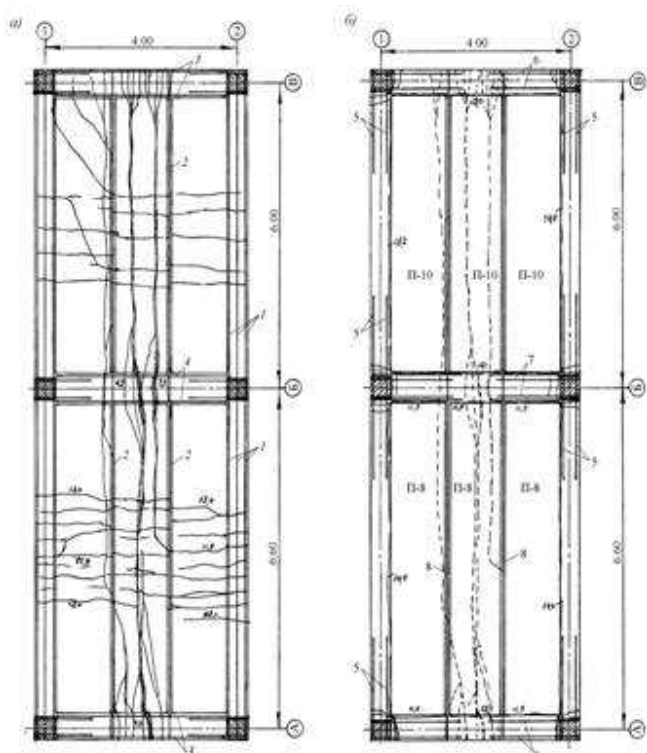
Картина трещин в диске перекрытия и характер разрушения; а - армирование и вид диска перекрытия после разрушения снизу, б - то же сверху, 1 - арматура связевого ригеля, 2 - затяжка, 3 - нижняя арматура крайнего несущего ригеля, 4 - то же среднего ригеля, 5 - верхняя приопорная арматура связевых ригелей, 6 - то же крайнего несущего ригеля, 7 - то же среднего несущего ригеля, 8 - верхний стержень межплитного шва.
